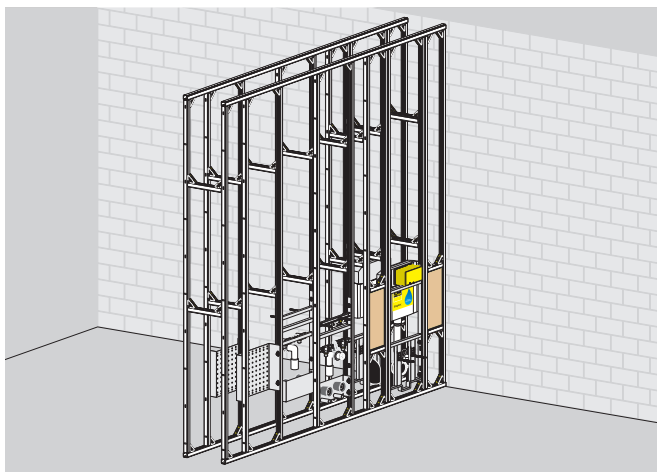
Ansicht einer Viega Installationstrennwand Eco Plus EI 120 (F 120) oder Steptec EI 120 (F 120) mit beidseitiger Installationsebene und Schachtinstallation nach dem Deckenabschottungsprinzip entsprechend den Viega ABP.
